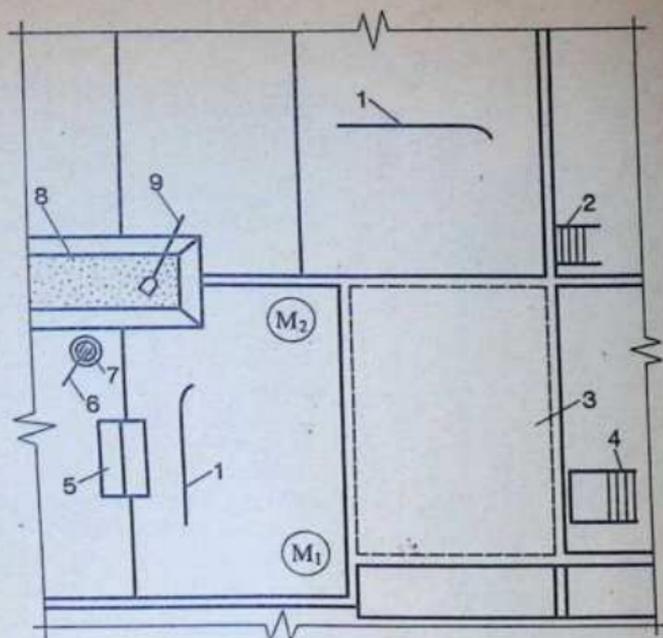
Схема организации рабочего места при укладке панелей перекрытия: 1 — лопы, 2 — лестница, 3 — место укладываемой панели, 4 — столик-стрелочка, 5 — столик с инструментом, 6 — сетла, 7 — ведро с водой, 8 — ящик с раствором, 9 — лопата; M_1 и M_2 — монтажные
